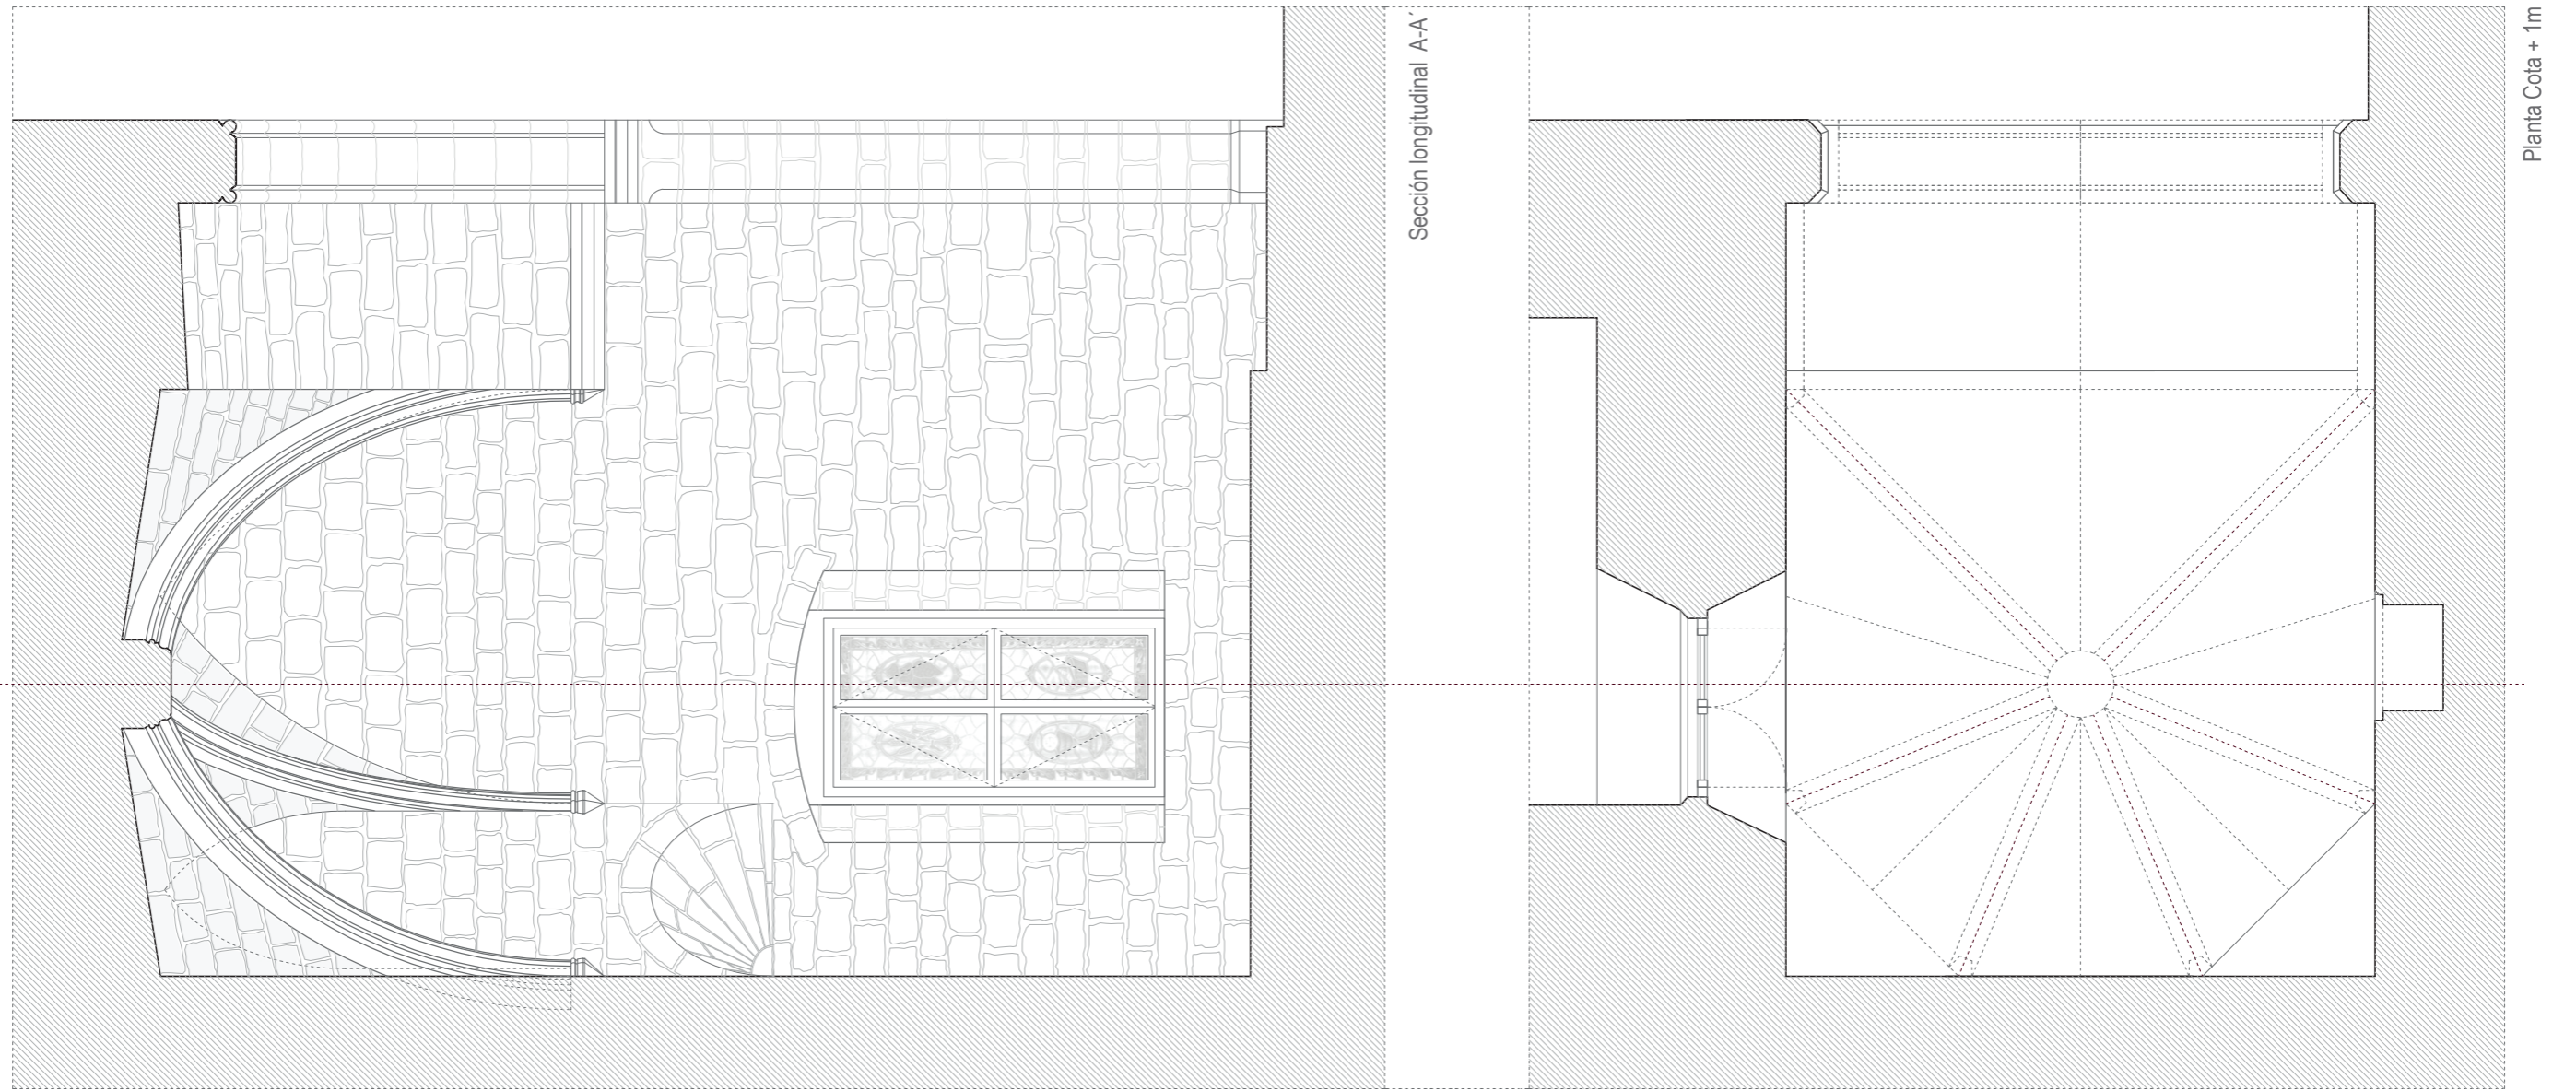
Planta y sección de la capilla a escala 1:50 (Dibujo propio)
